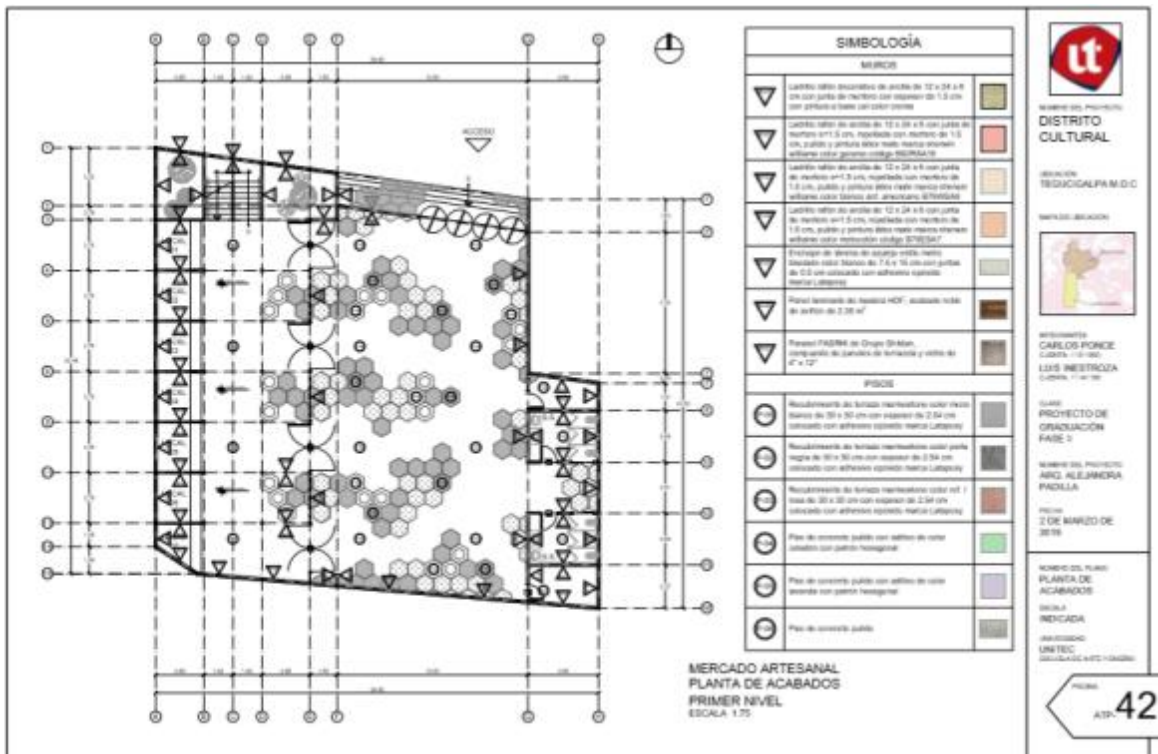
Planta de Acabados Mercado Artesanal Primer Nivel
